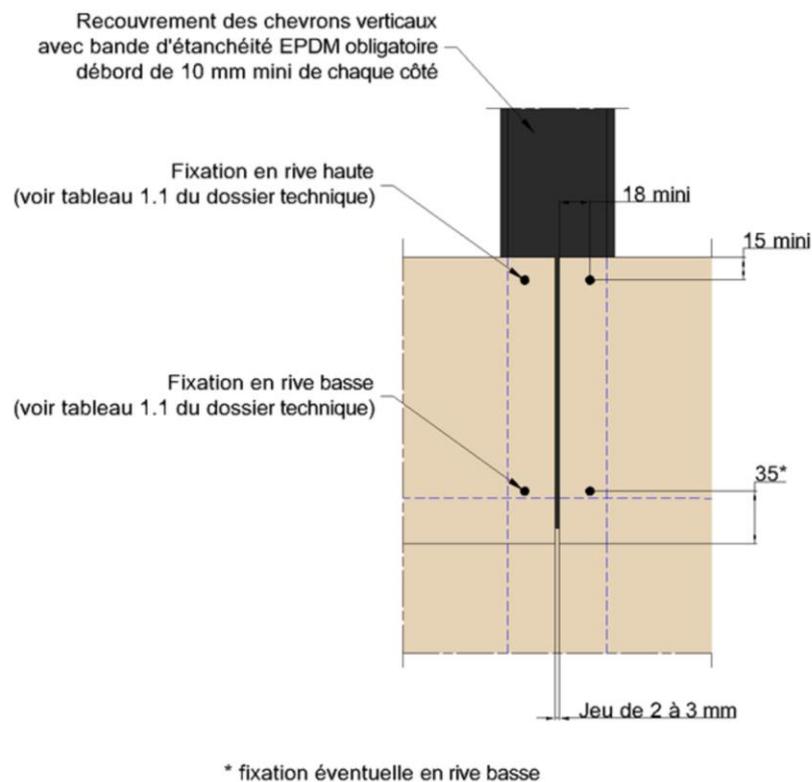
Jonction entre deux lames CEDRAL LAP – Pose horizontale
